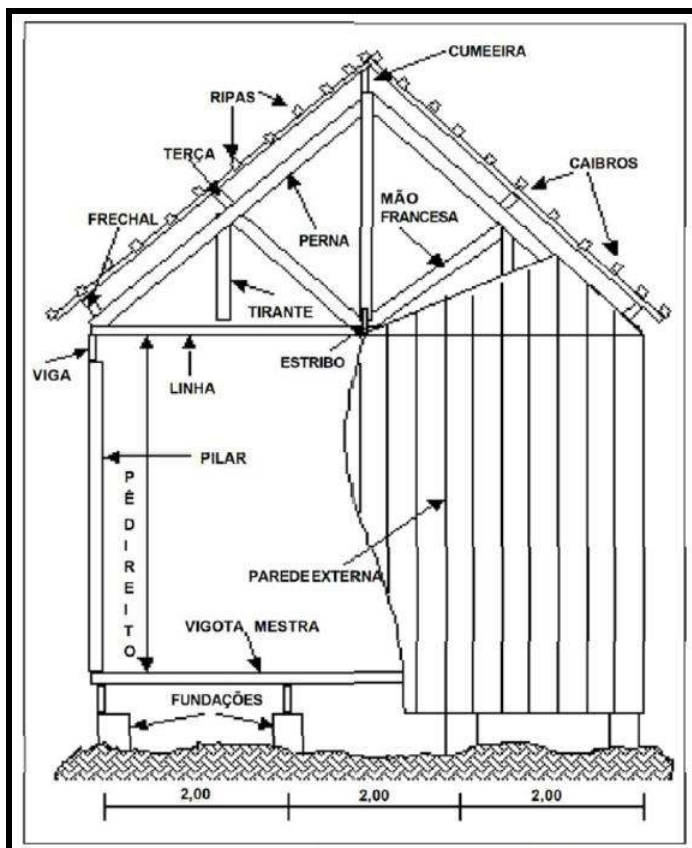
Pavilhão de 6,00 x N metros – vista lateral
